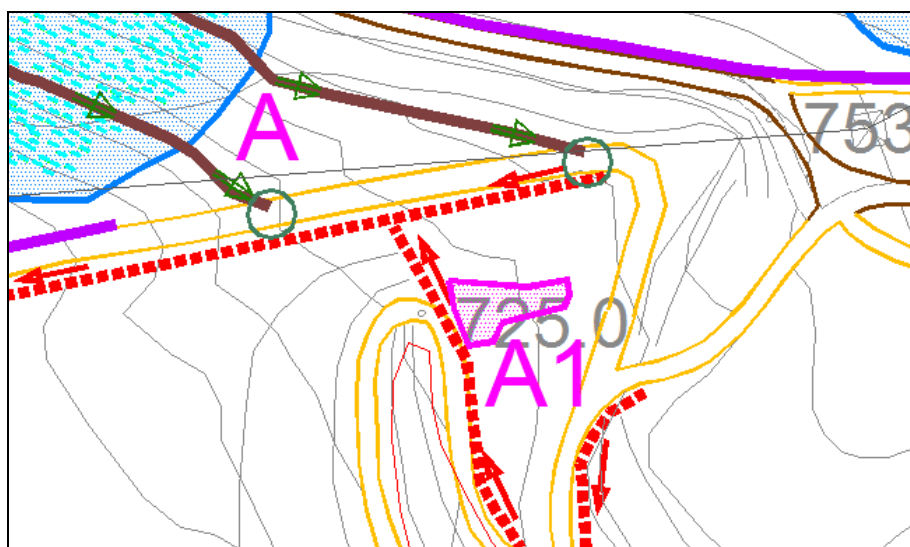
Unità progettuale A1 (cfr. elaborato C2 - Planimetria generale di progetto)
